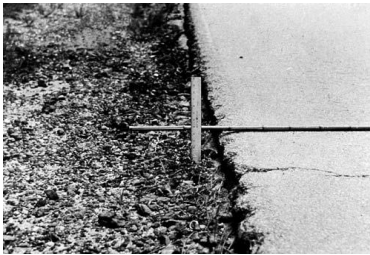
Retak Memanjang atau Retak Melintang (*Longitudinal and Transverse Cracking*)
